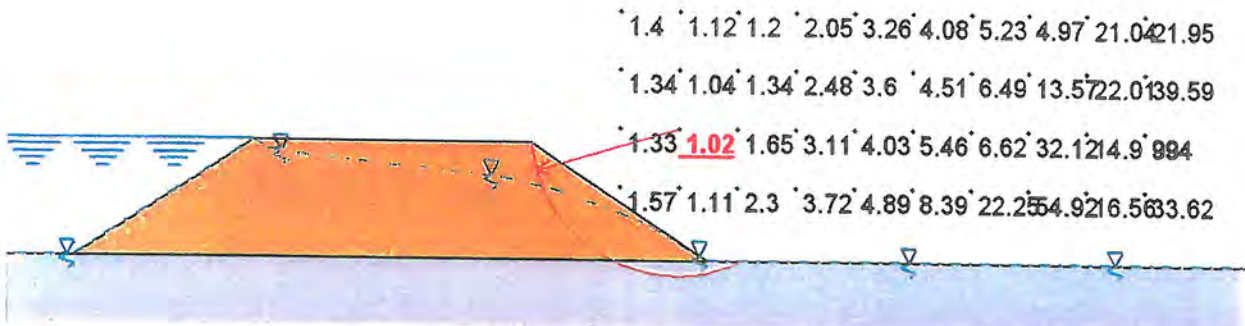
Glissement de talus pour un ouvrage fondé sur des sables
